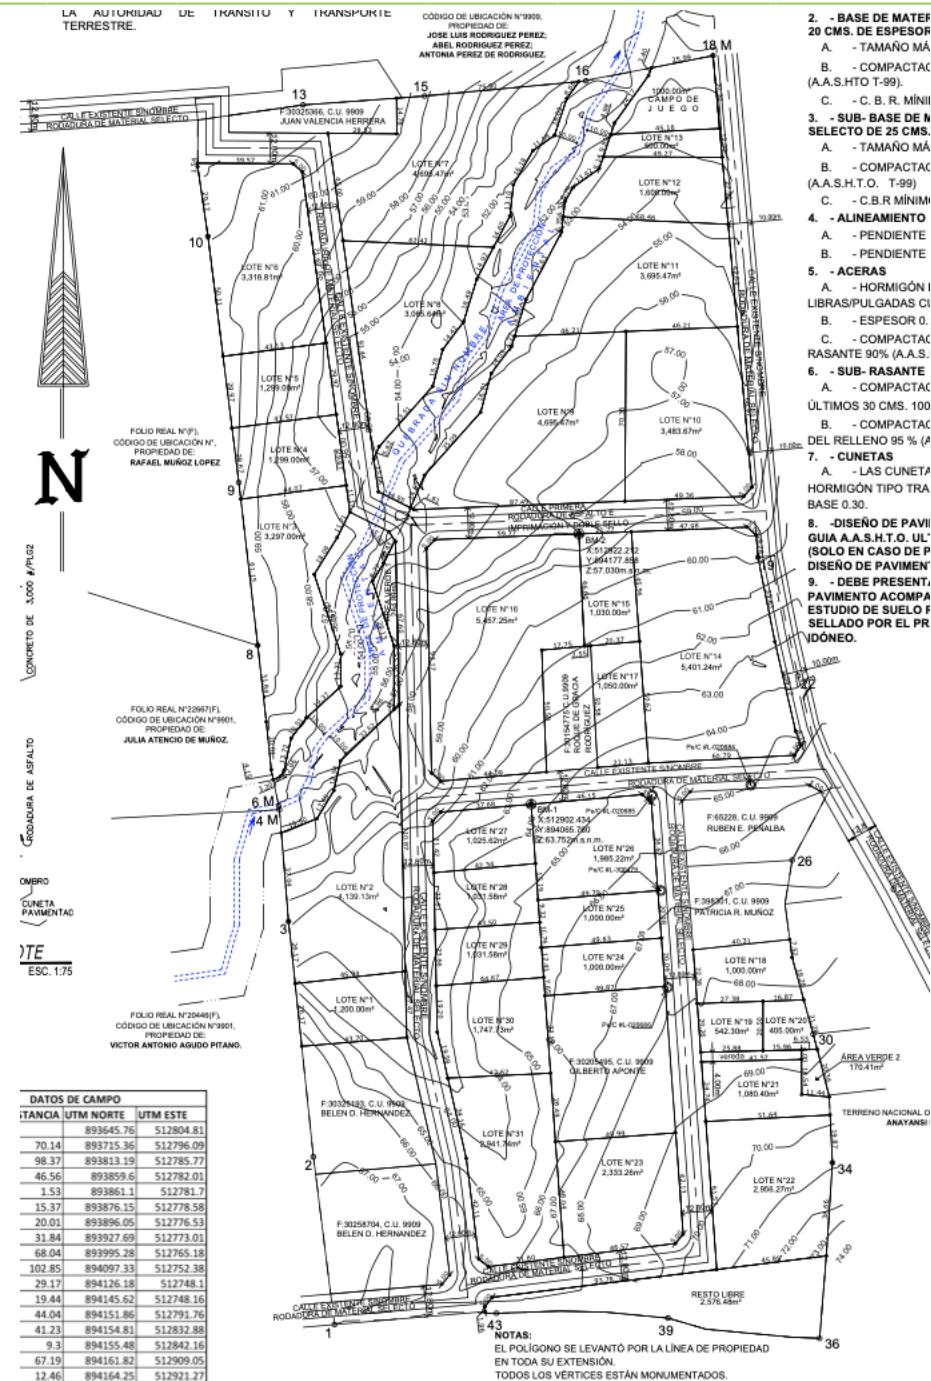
Vista general (sin escala) de la planta de lotificación
